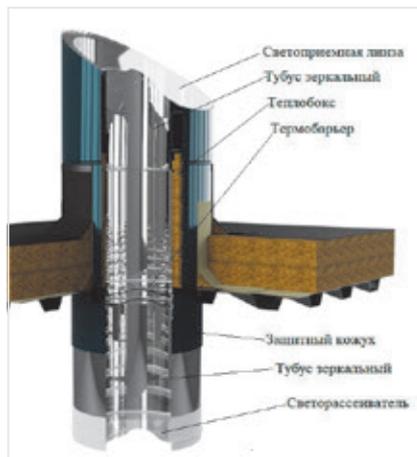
Устройство световода «Энергоэффективные строительные конструкции»
